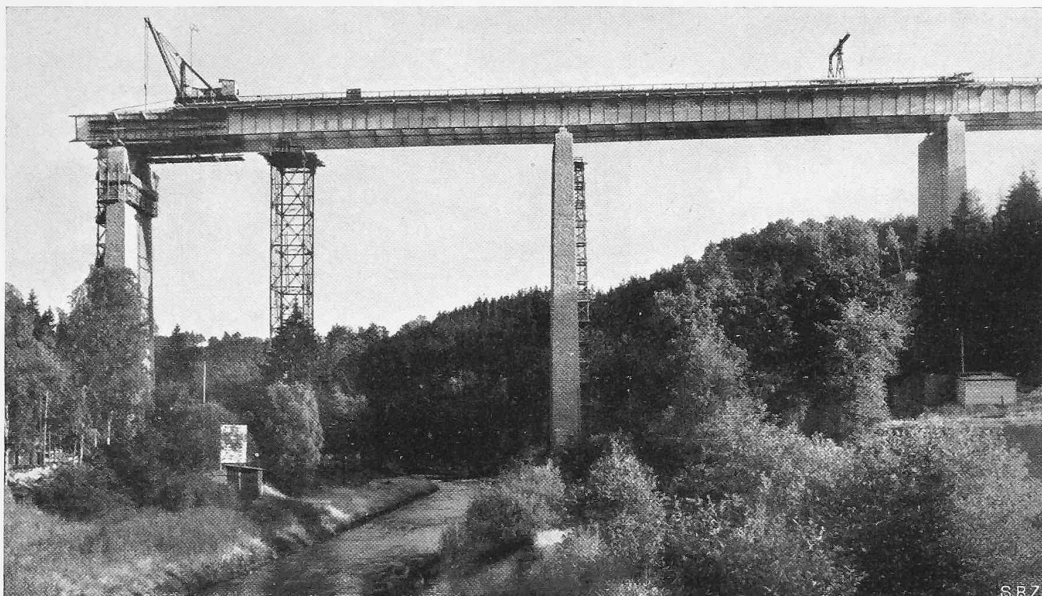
Reichsautobahnbrücke über das Muldental bei Siebenlehn, 403 m lang, 70 m hoch, 24 m breit. Durchlaufender Vollwandbalken 2850 t St. 52 u. 37 genietet. Eisenbetonpfeiler mit Verblendung aus Meissner Granit.
